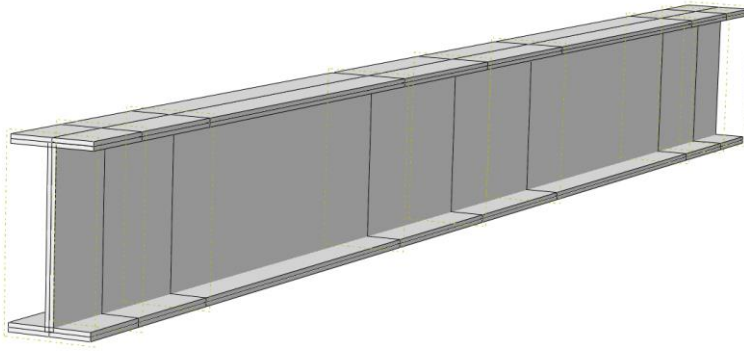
Abaqus Programı Assembly Modellemesi
